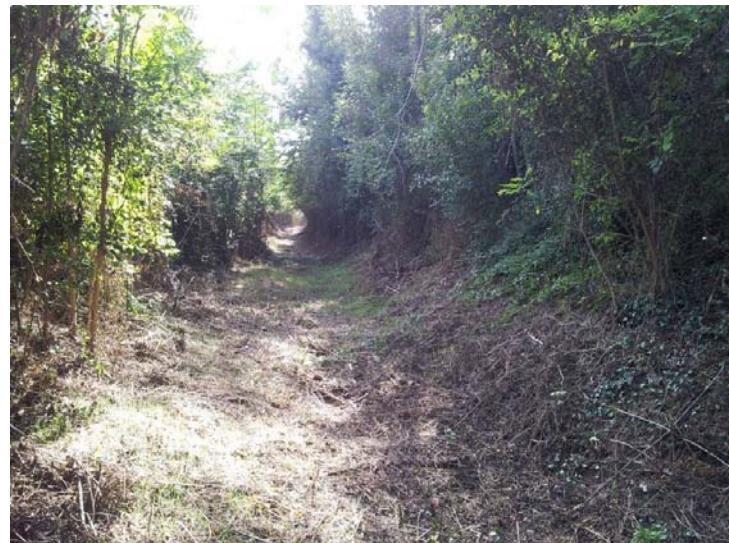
vista della zona compresa tra il rilevato della superstrada e la ferrovia
